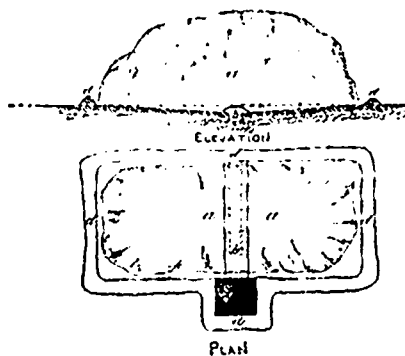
Coupe transversale et plan d'une plateforme étanche à arc concave pour le fumier.
